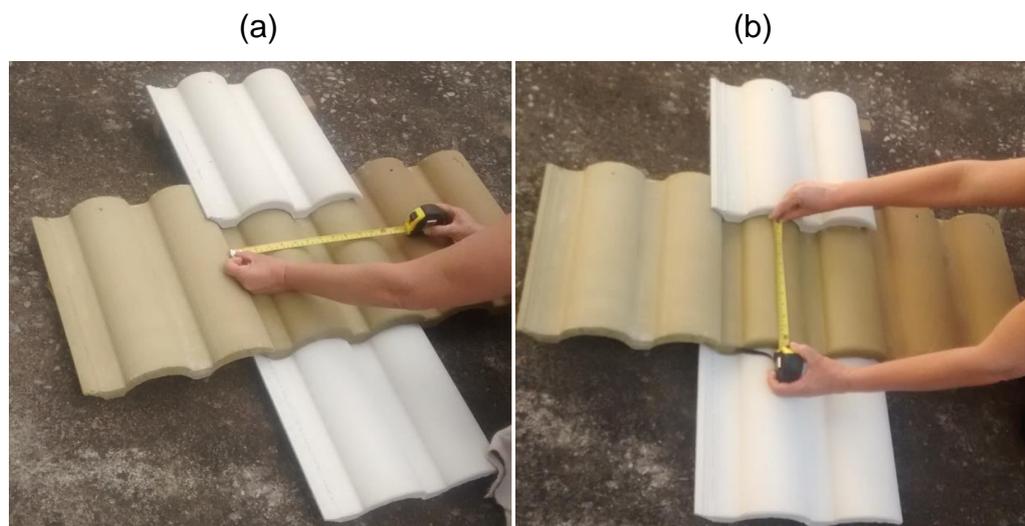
Telha cerâmica: a) Mensuração da largura útil, b) Mensuração do comprimento útil.
